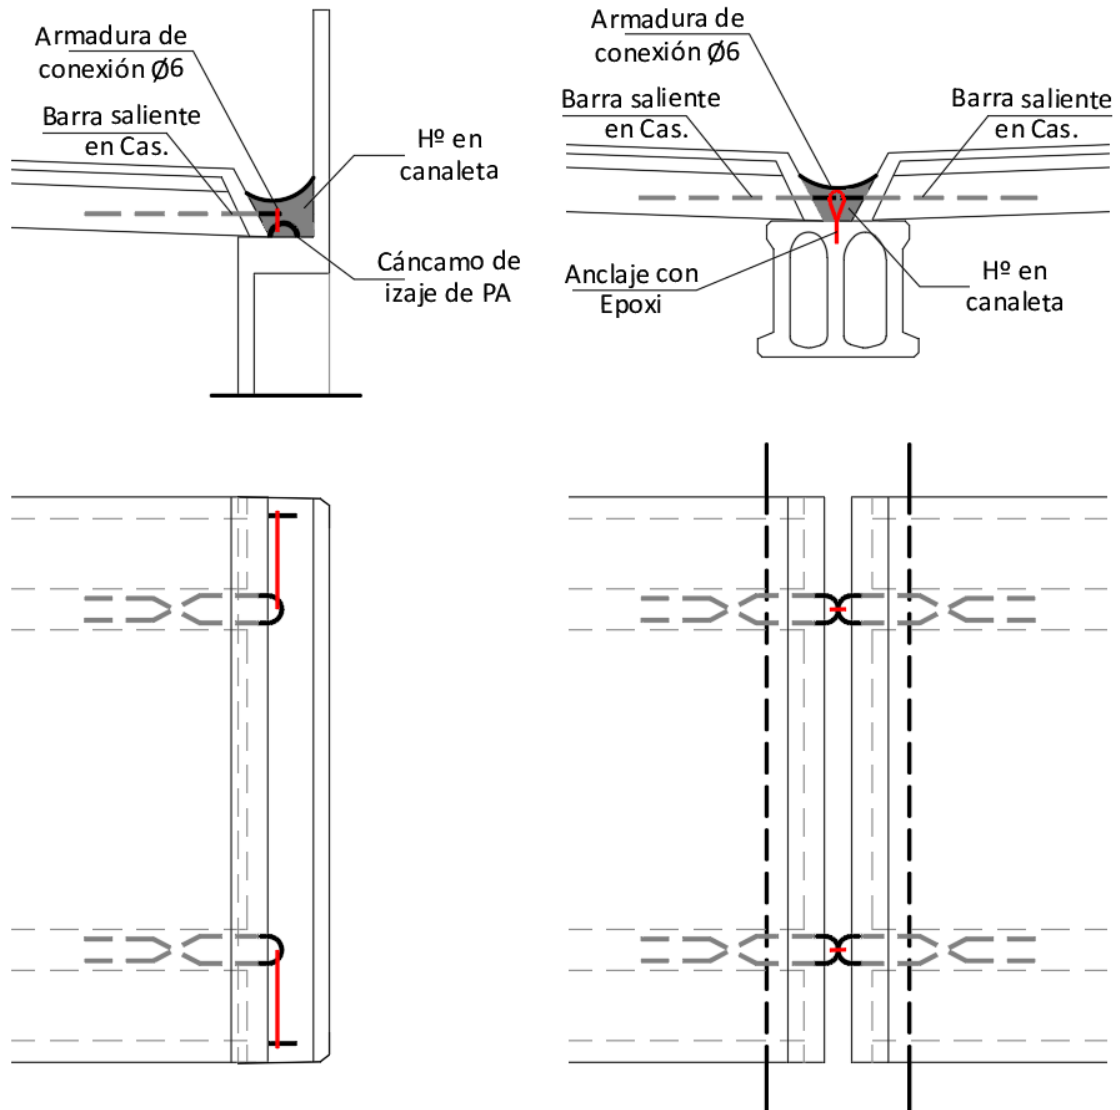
(Izquierda): Vinculación de paneles de cubierta y paneles autoportantes de apoyo
